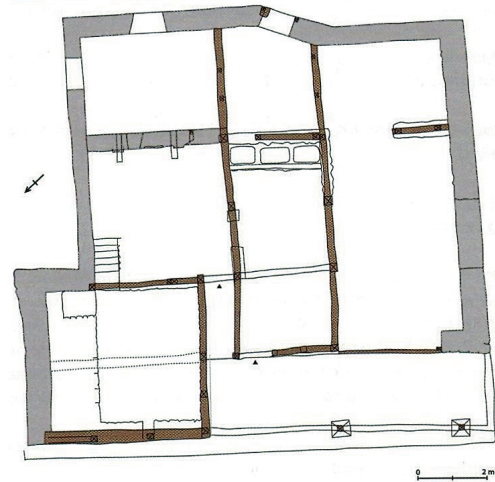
Plan de la ferme Masuy à Rahier.
